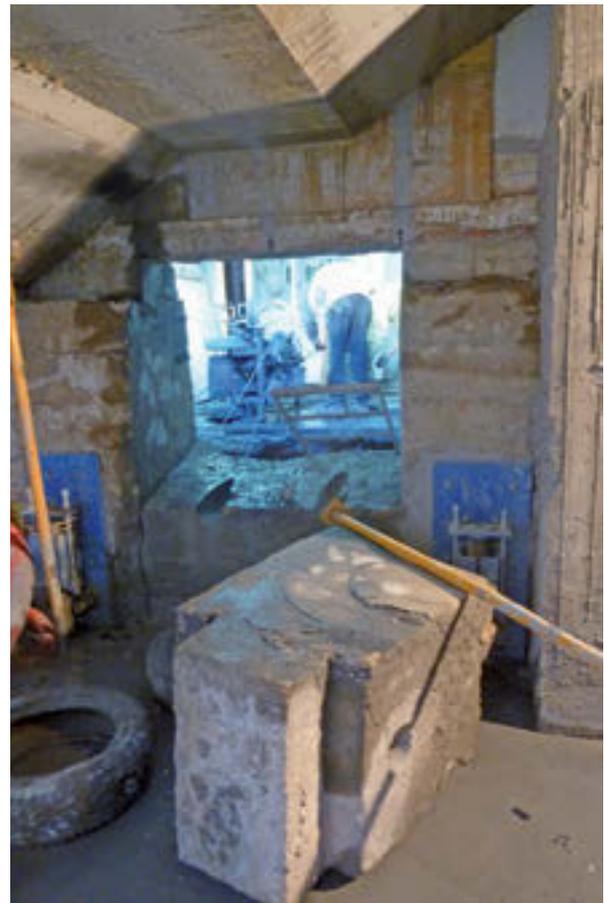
Huelco parcial realizado mediante equipo de corte de hilo de diamante. Se aprecia un primer bloque de hormigón. Vista desde el lado de la ampliación.
